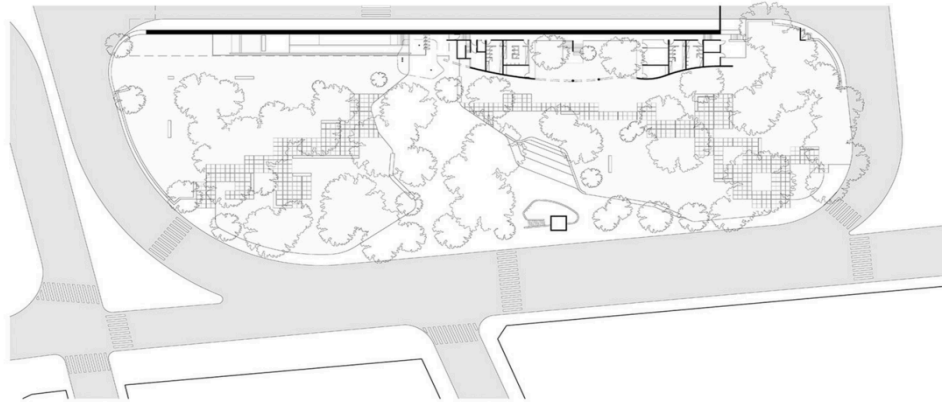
Plan Urbano, Terminal Da Lapa Fuente: Núcleo Arquitectura
